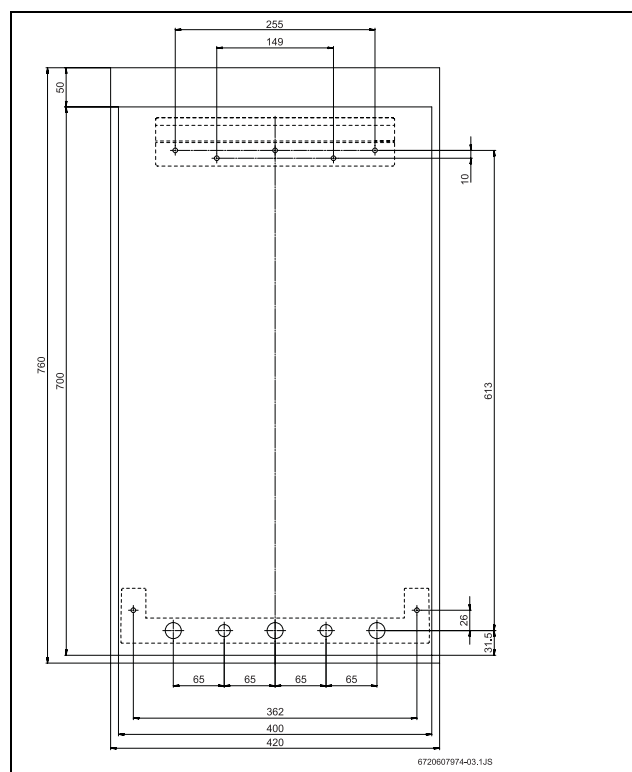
Montage de la traverse d'accrochage et de la plaque de pré-installation
